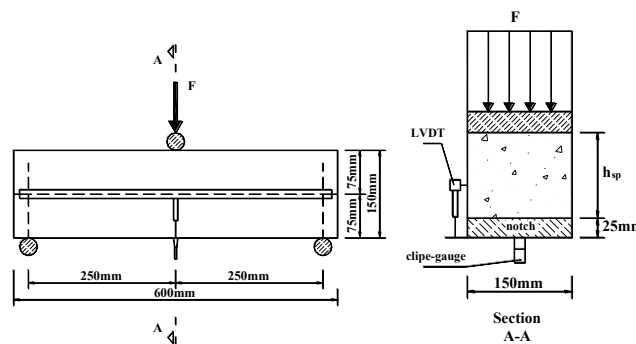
Ensaio de flexão sob três pontos de carga em viga entalhada (Vandewalle *et al.* 2000a).
